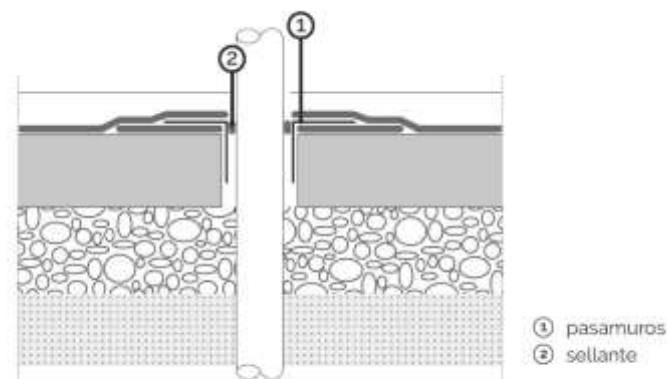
Encuentro de la barrera tipo lámina con un elemento pasante vertical mediante un pasamuros
